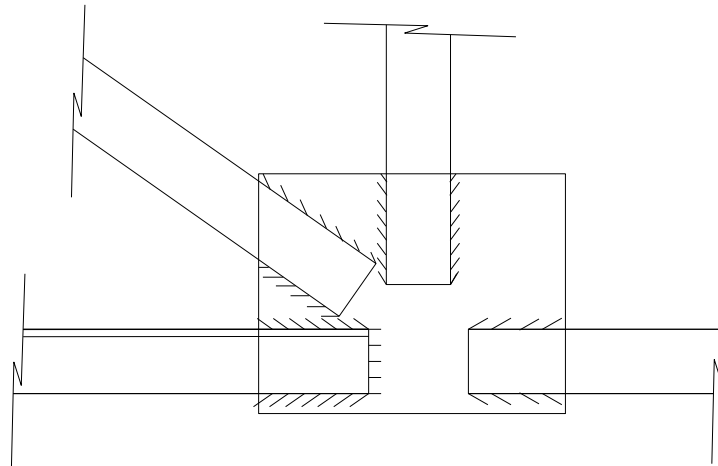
Conexión soldada en todo su perímetro con la placa de conexión.
